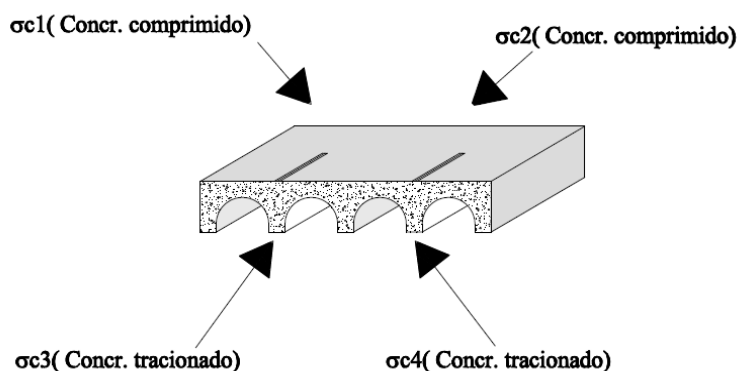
Esquema das tensões verificadas no concreto para os painéis de laje
